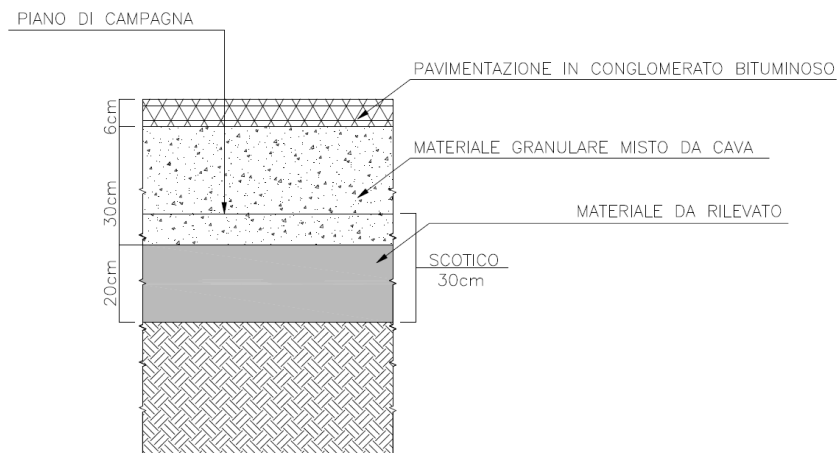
pacchetto di pavimentazione nelle parti asfaltate
